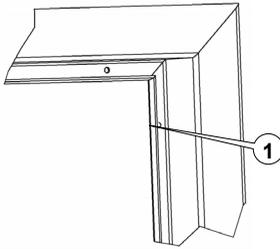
Bohrungen in der Dichtungsnut Eckzarge EZ1
